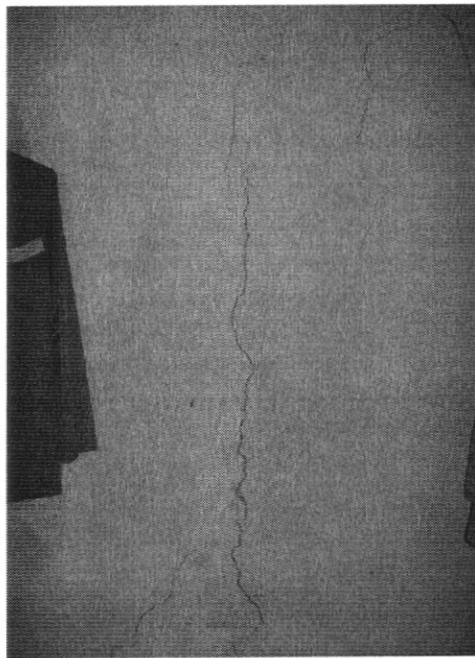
Detalle de la continuidad de las grietas mostradas en la fotografía 1 en el segundo nivel de la vivienda de la Carrera 12 No. 48C-28 Sur
